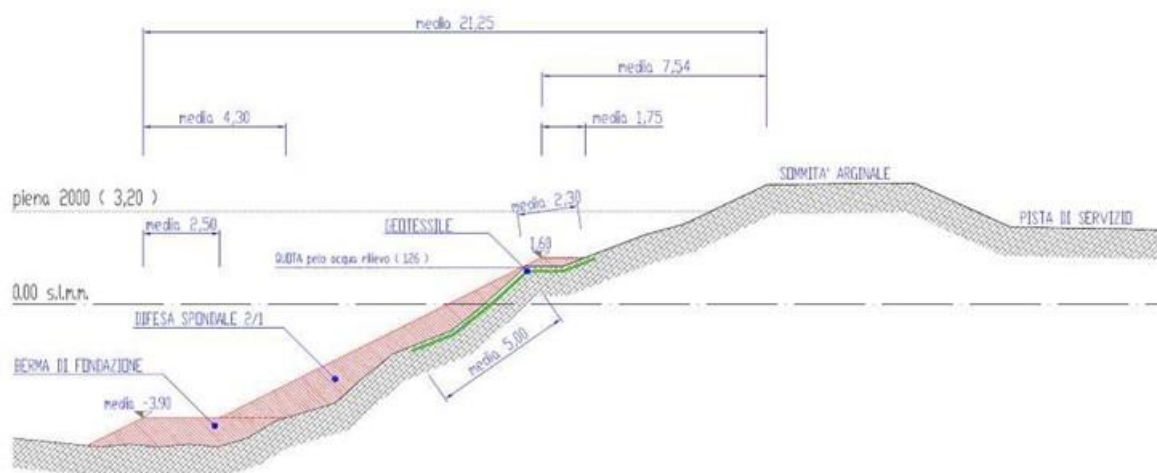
Esempio 2: sezione tipo difesa spondale Po.
